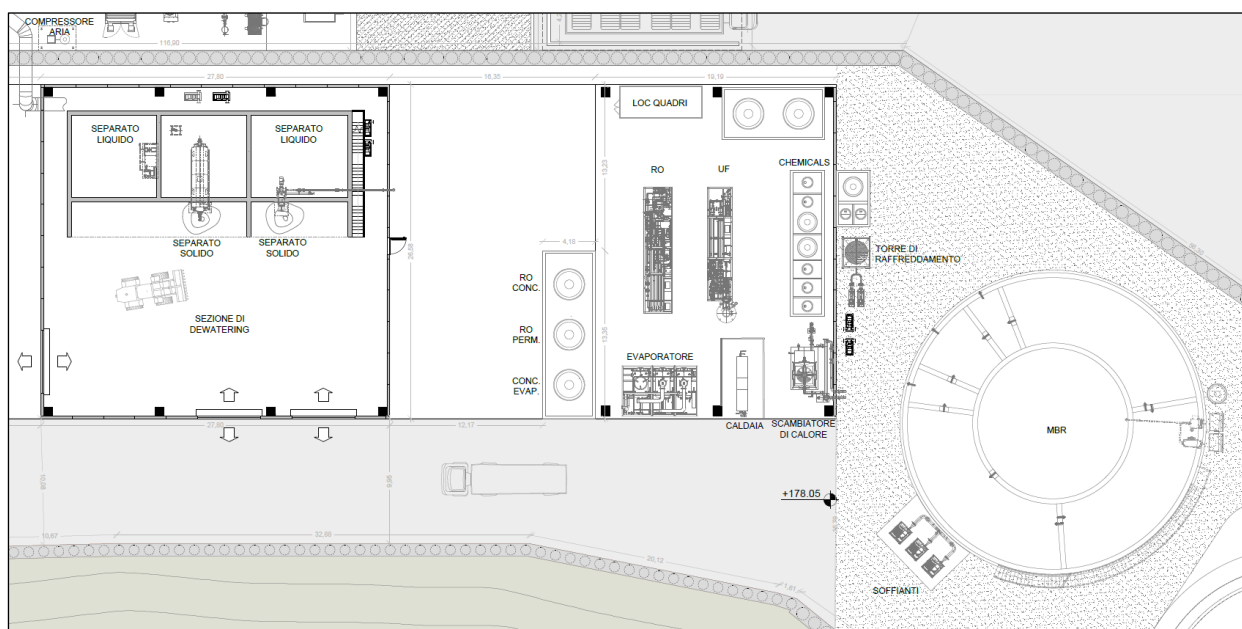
Layout impiantistico della sezione di depurazione del digestato
